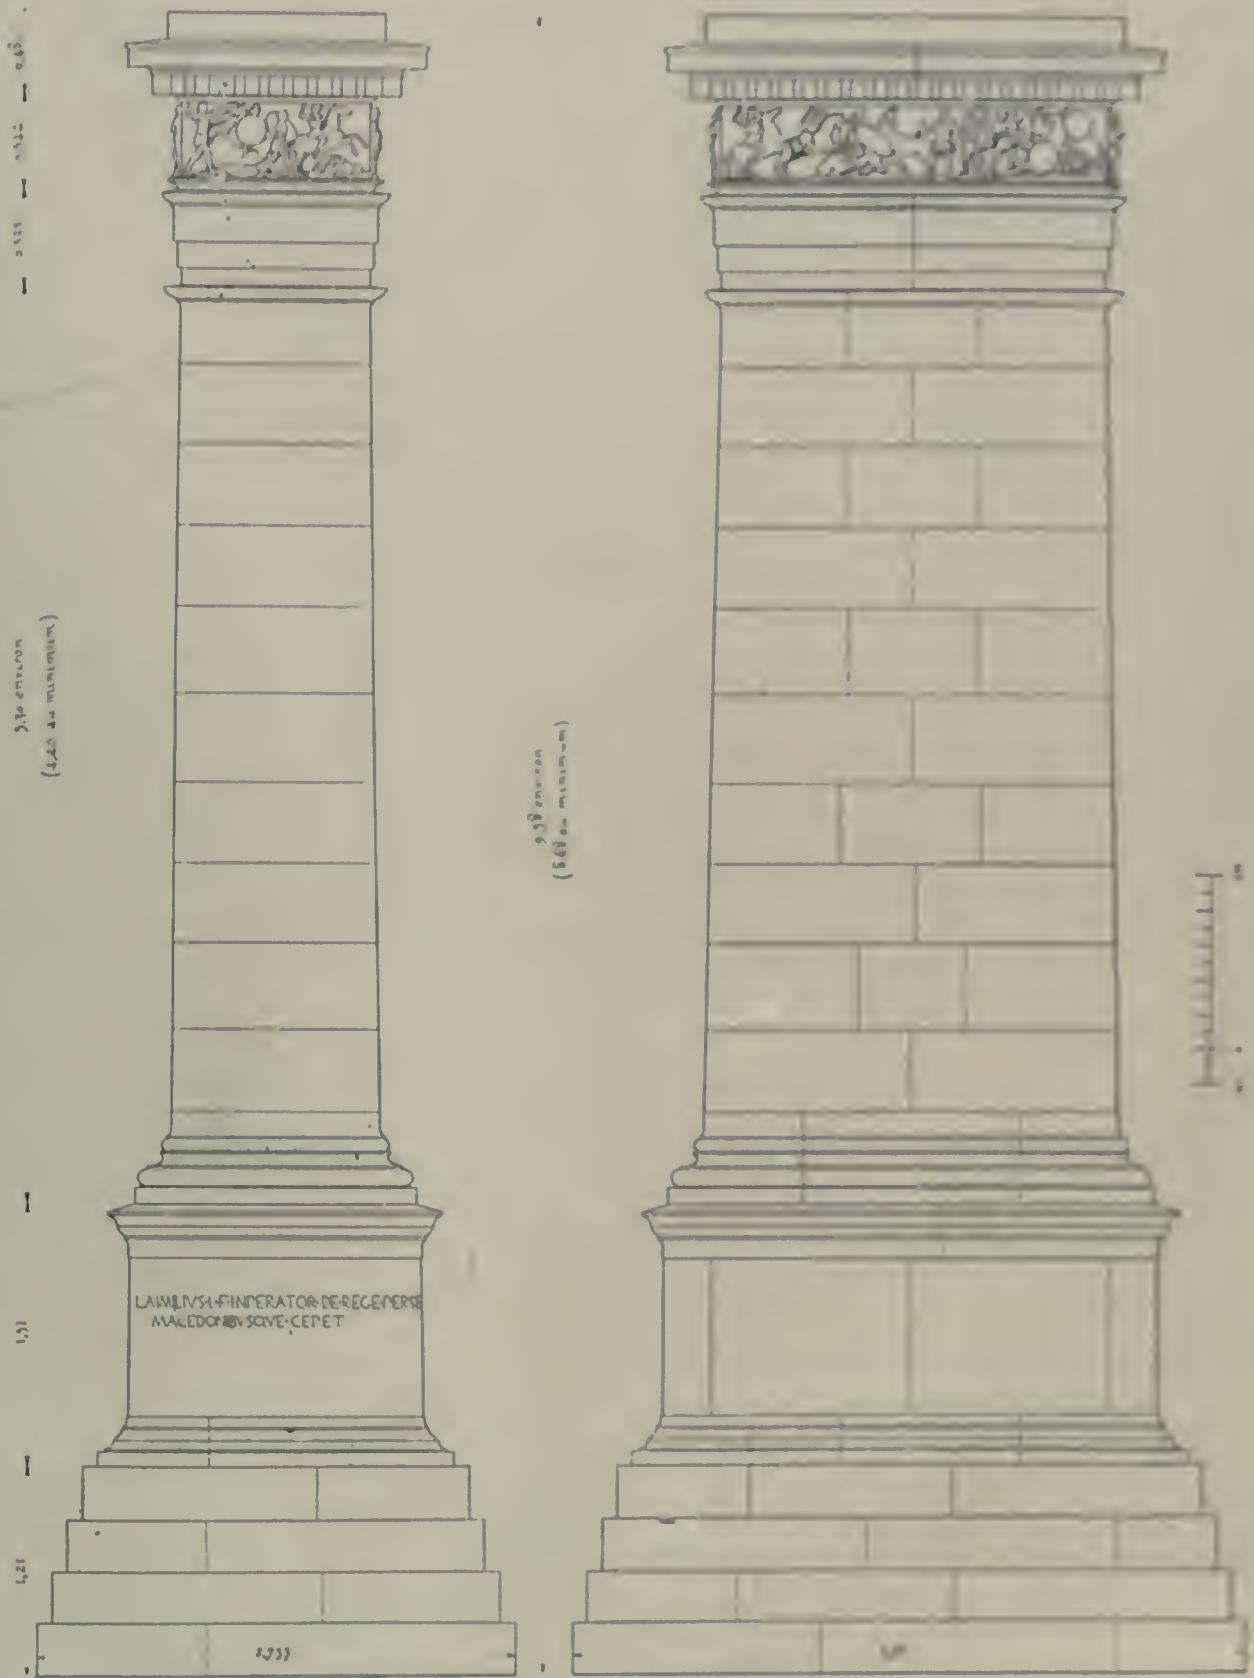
Monument de Paul-Jeanne. Plan de reconstruction.
